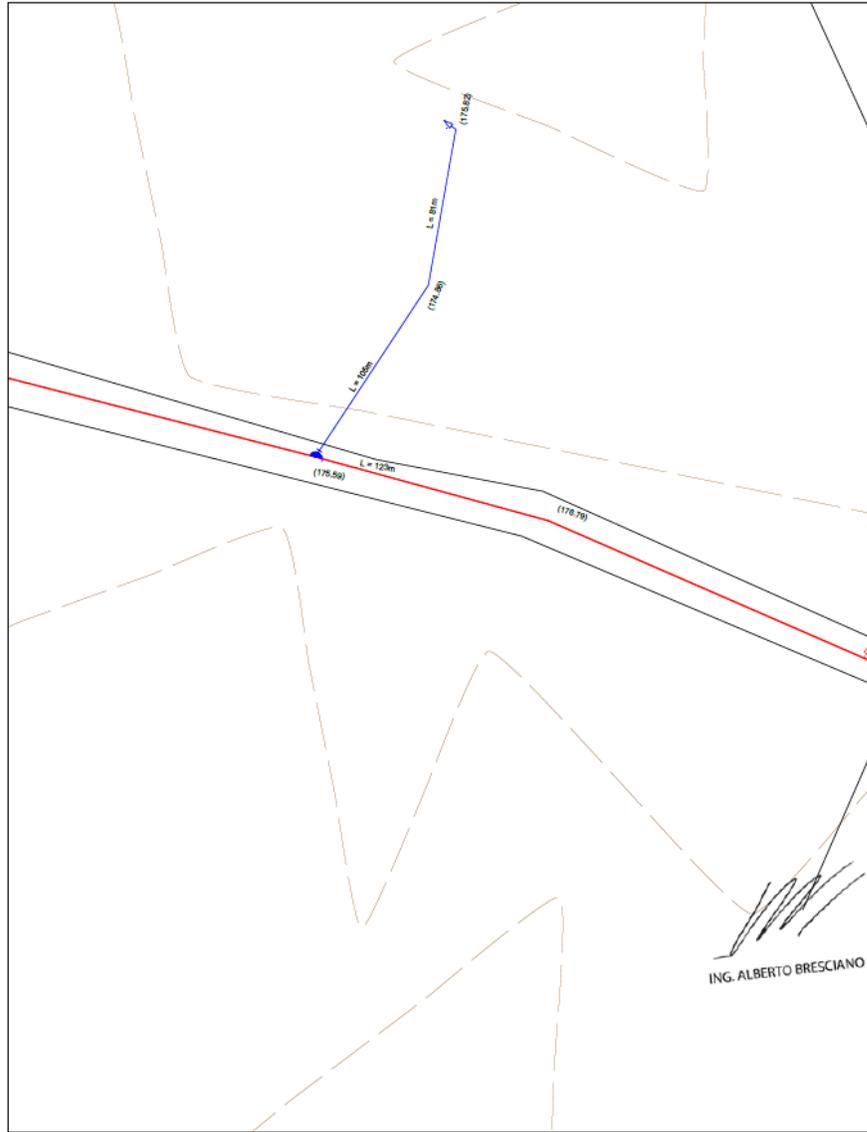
Planimetría de la obra en la Localidad de El Tuscal
